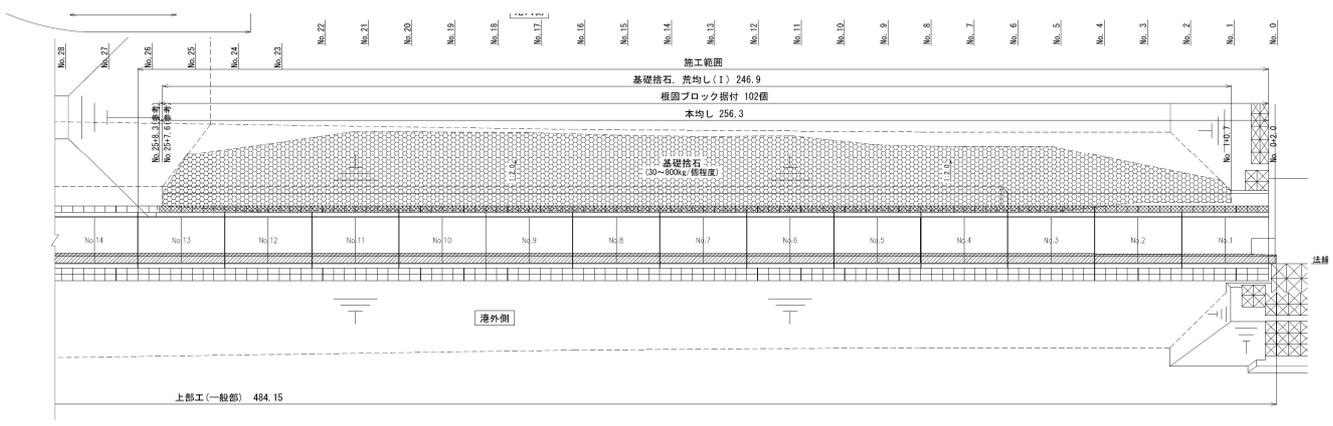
No.1 常陸那珂港区_北防波堤平面図② (復旧後)
